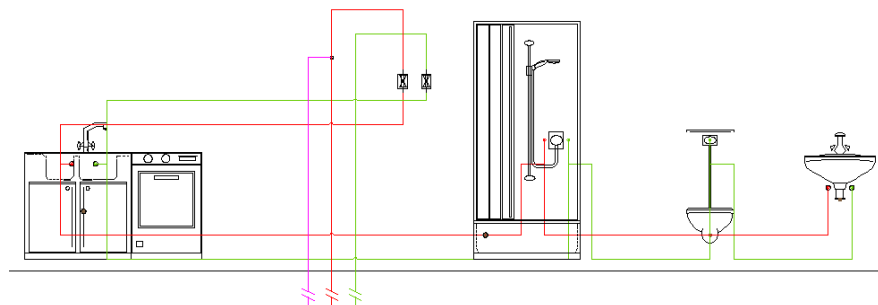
Beispiel einer durchgeschleiften Stockwerksinstallation
